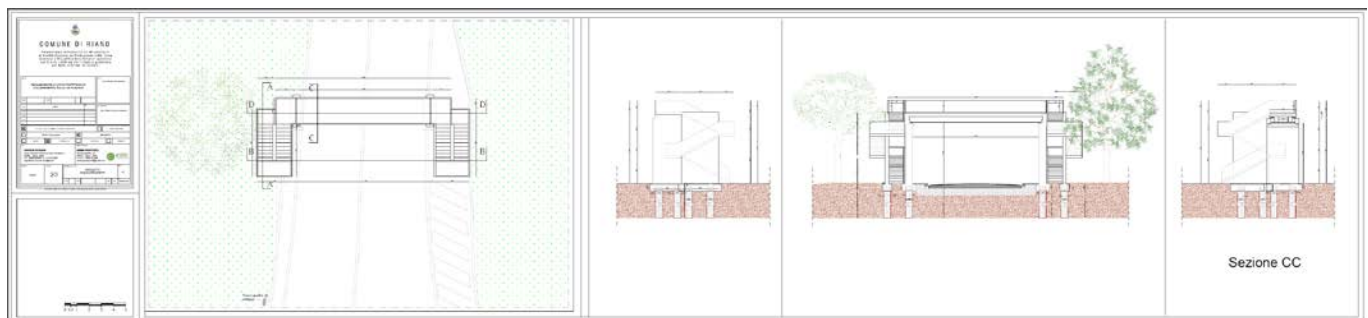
Tavola A23: pianta, prospetto e sezioni del sovrappasso
